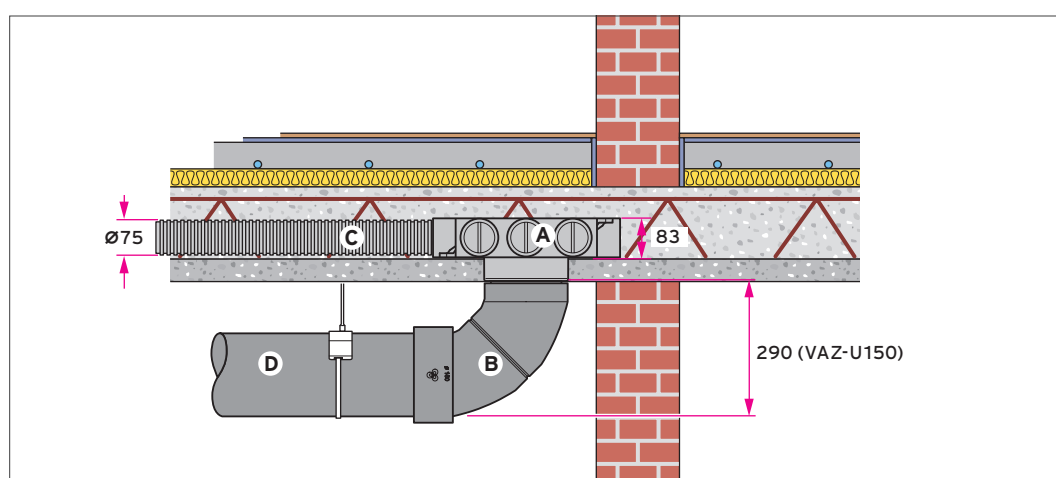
Niedrigbauverteiler/Sammler für runde Luftschläuche in der Rohbetondecke, Schnittdarstellung
